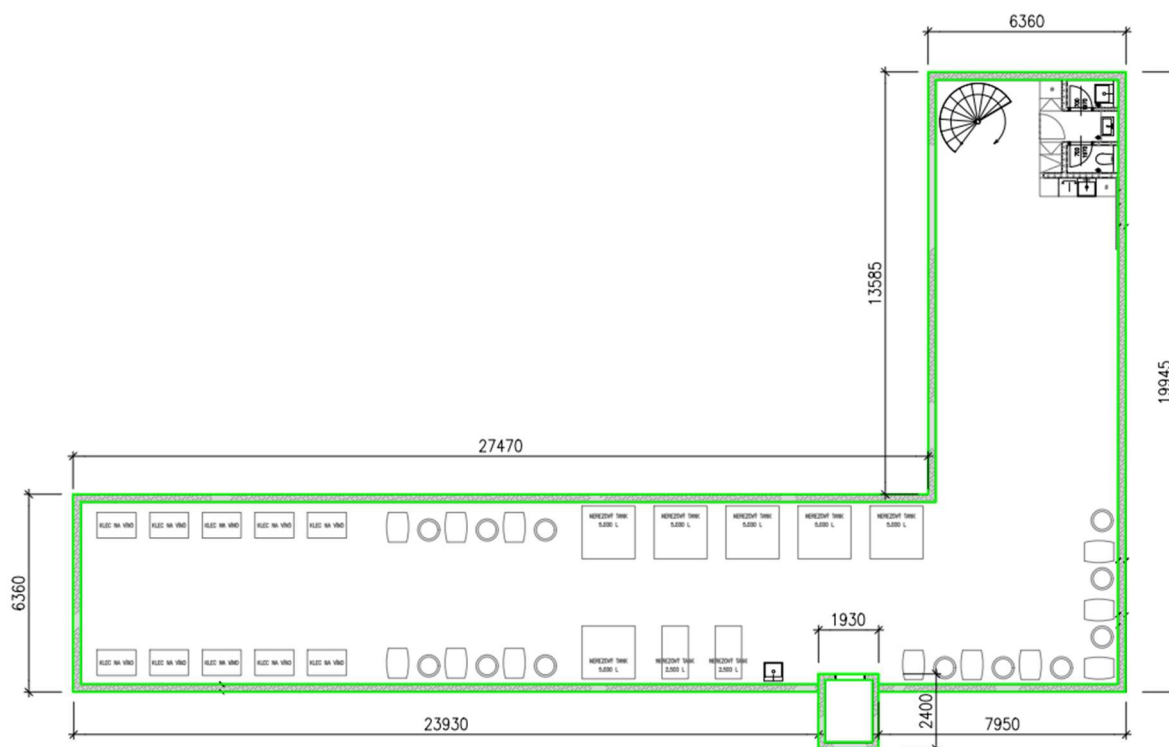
Betonáž ŽB stropní desky 1.PP
